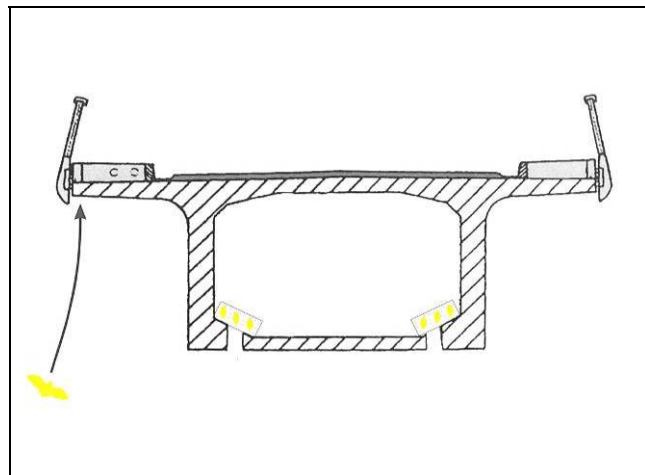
Nid de type « Bat tube » Schwegler. Photo :Schwegler.
